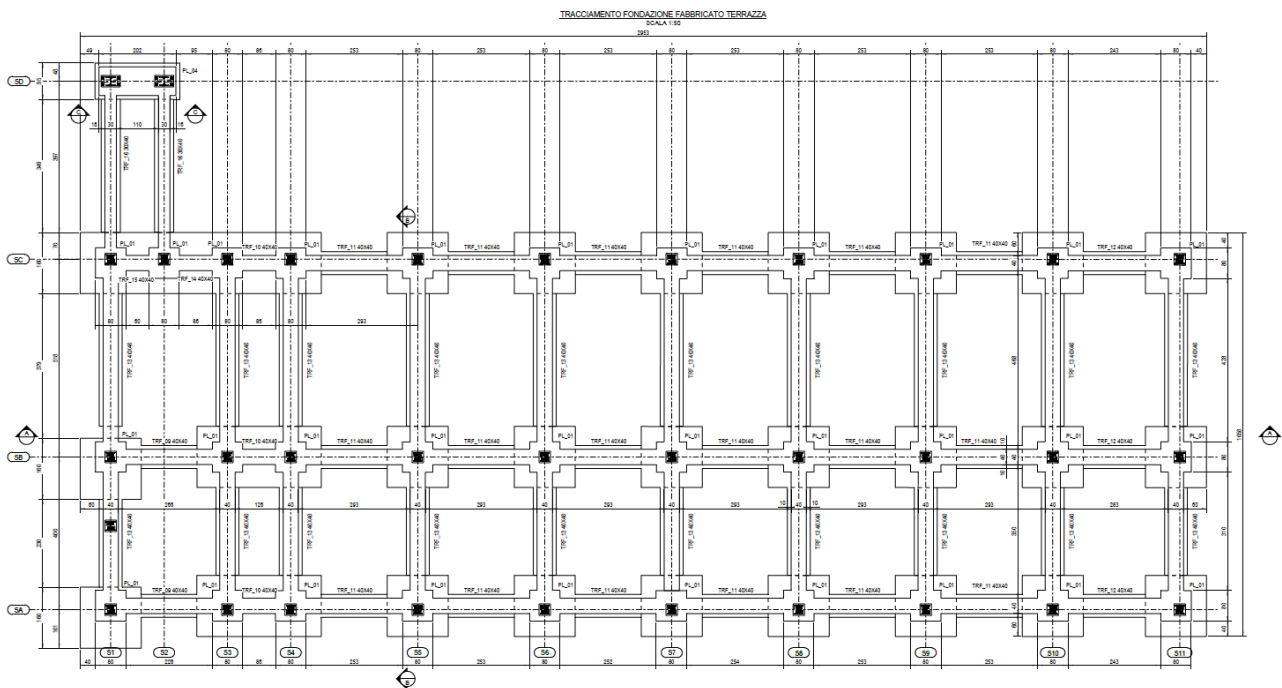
Ex Galoppatoio – pianta delle fondazioni Fabbricato 5
